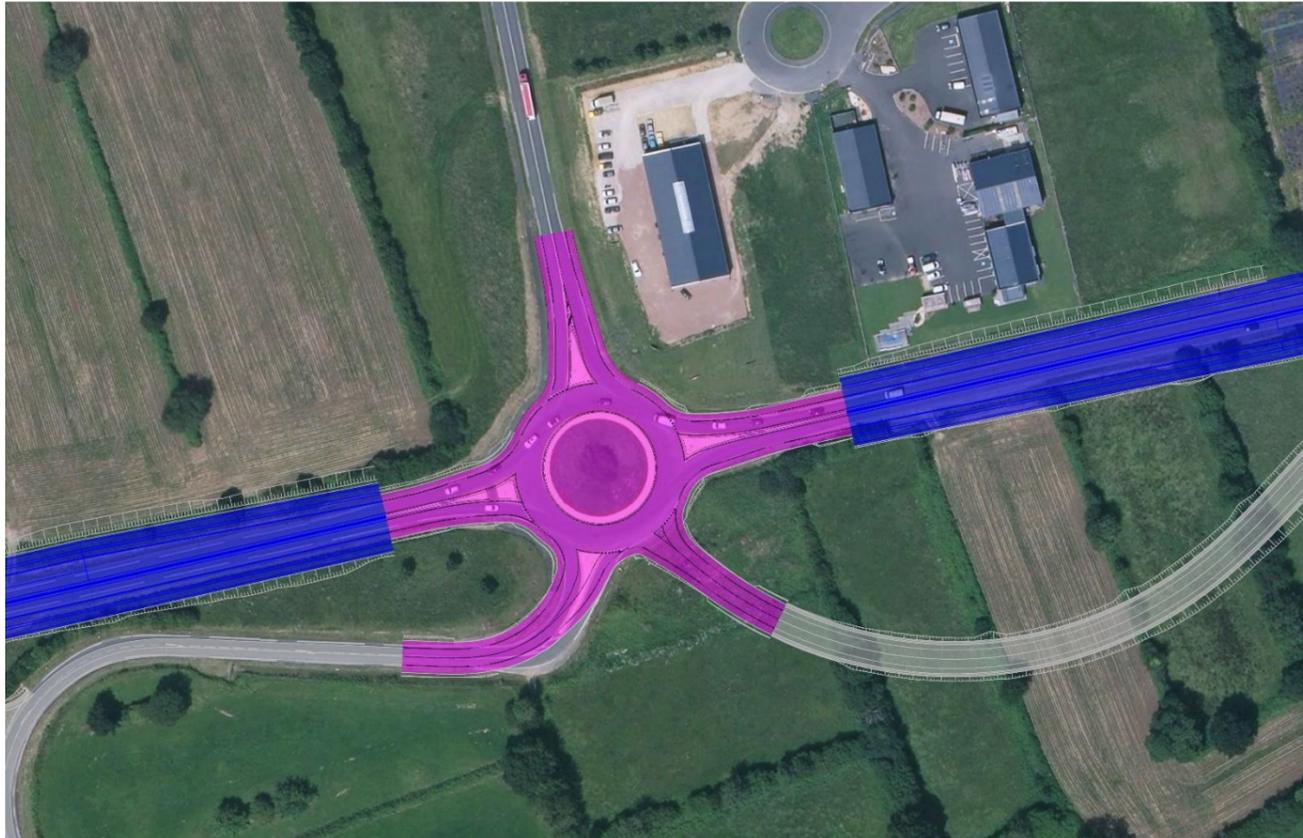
Vue en plan de l'aménagement du giratoire « La Chênée »
